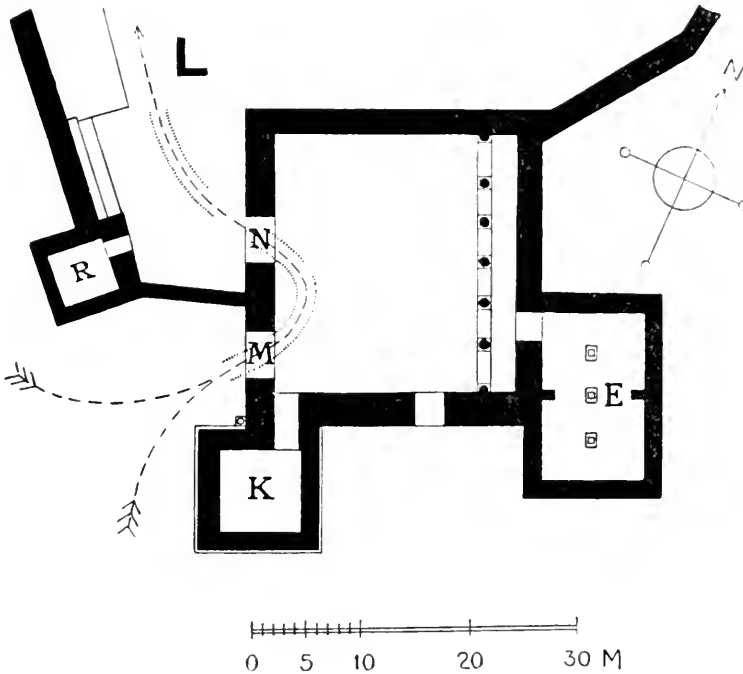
Grundriss des südlichen Stadthores.
